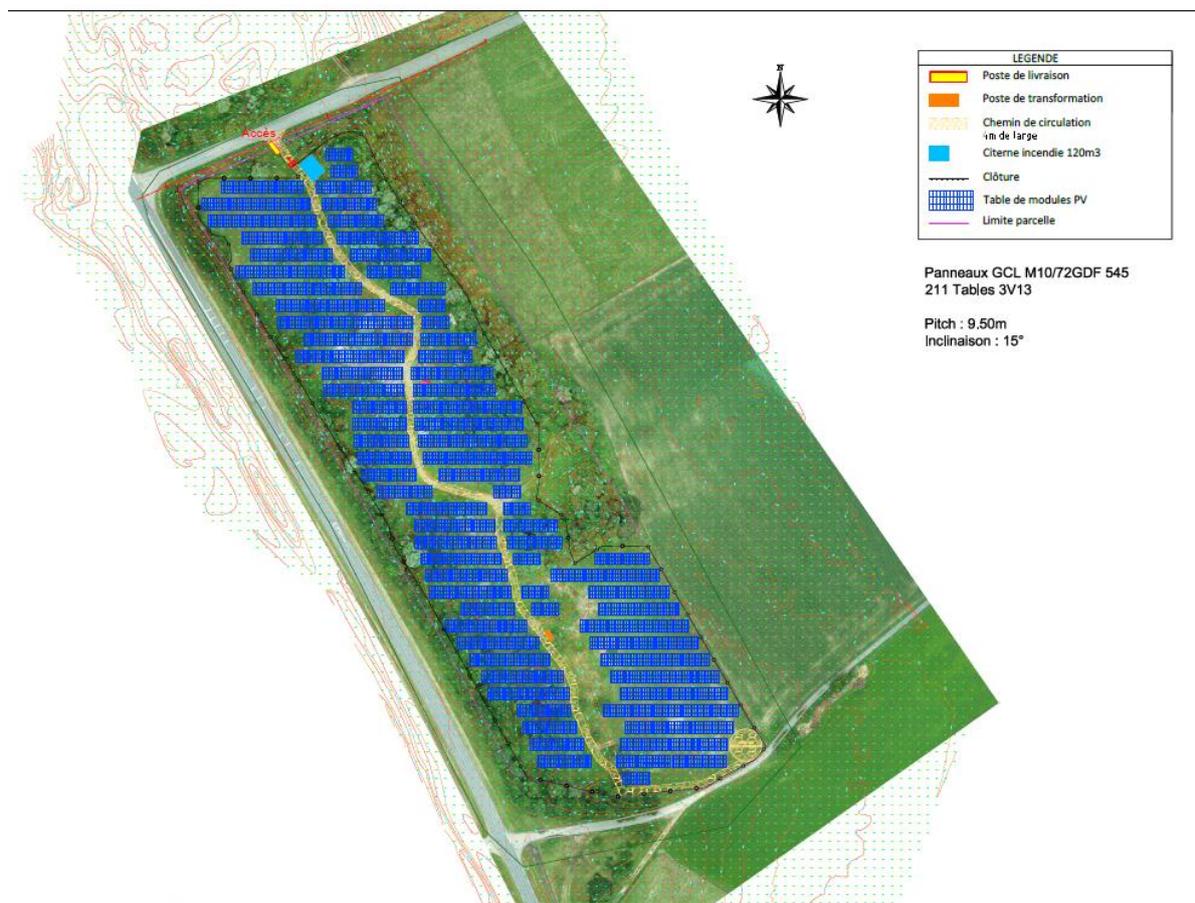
Variante n°2 du plan d'implantation (source : Générale du Solaire)
